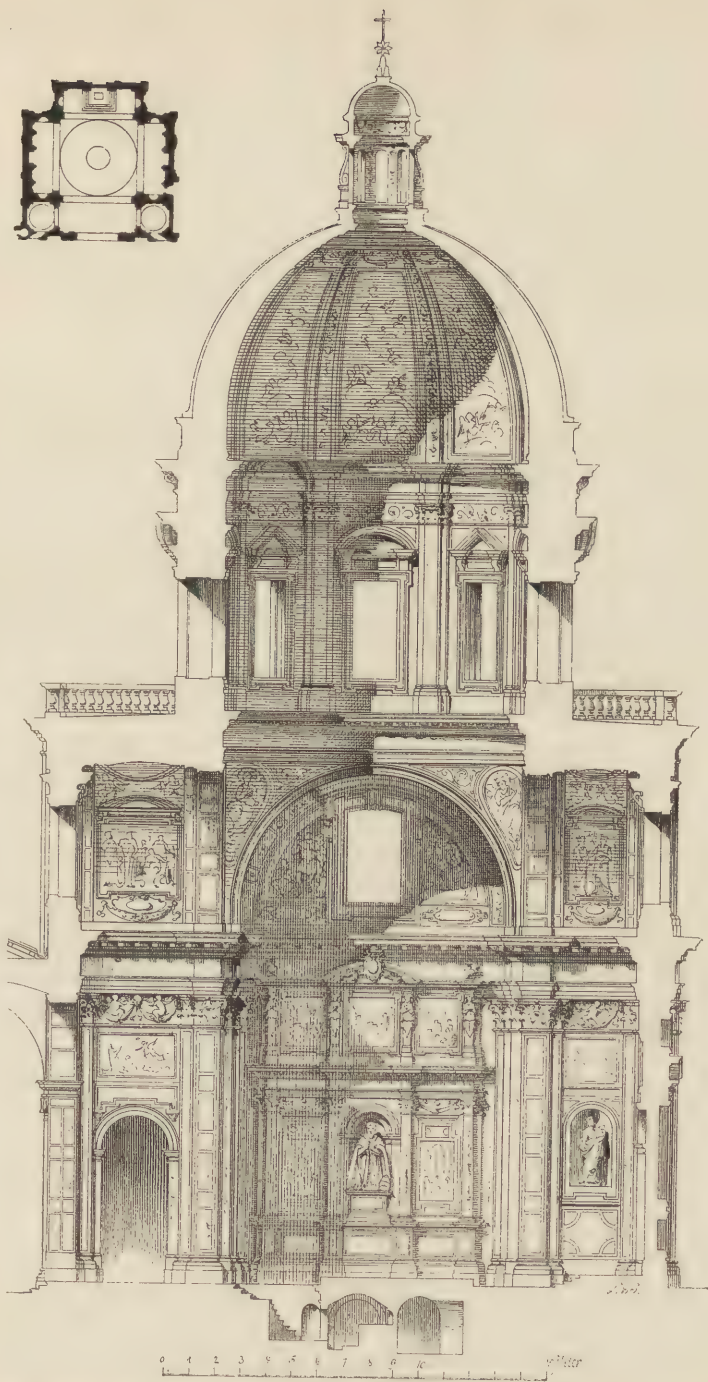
Capella del Presepio an St. Maria Maggiore zu Rom. Längsschnitt und Grundriss.
